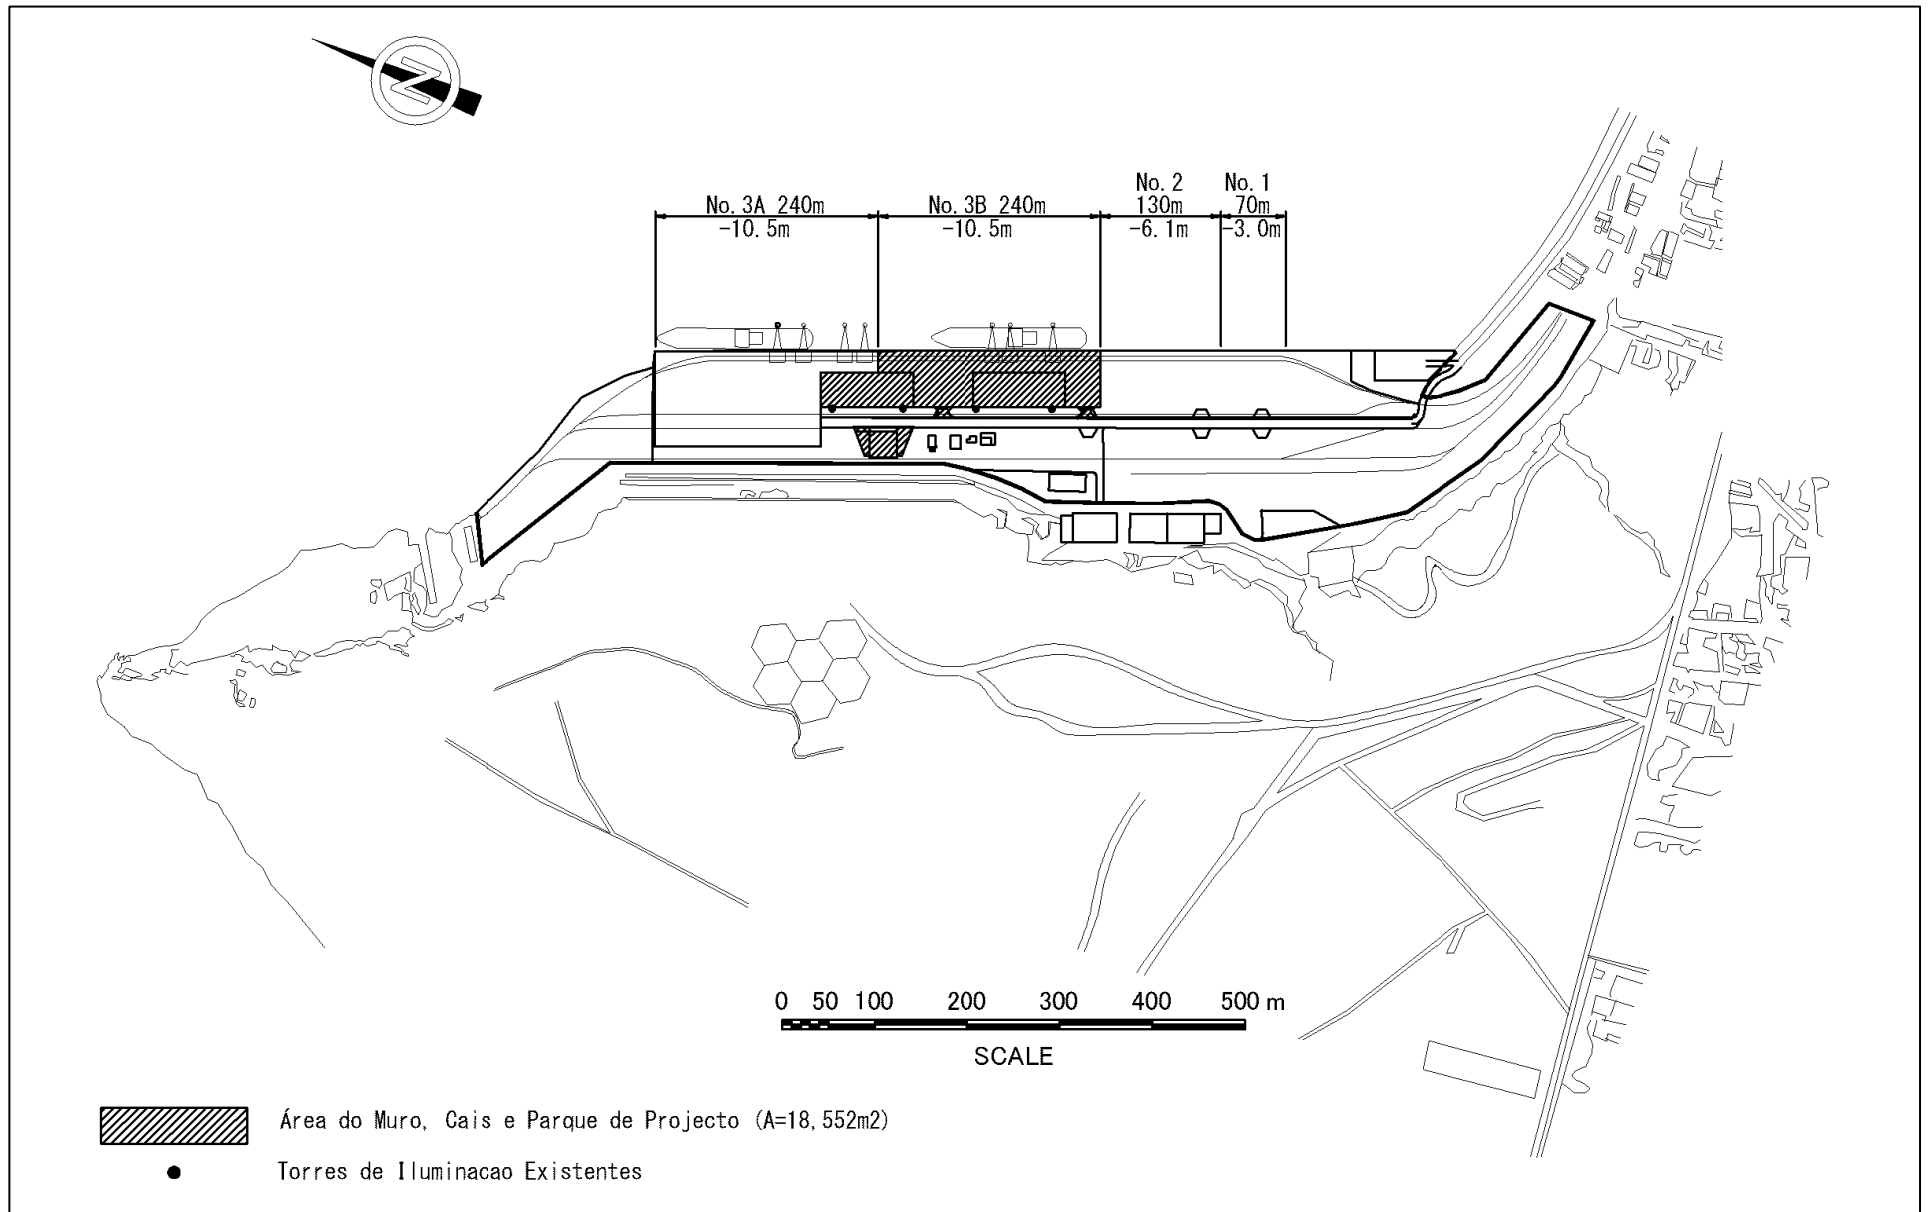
Planta Planimétrica do Porto do Namibe
